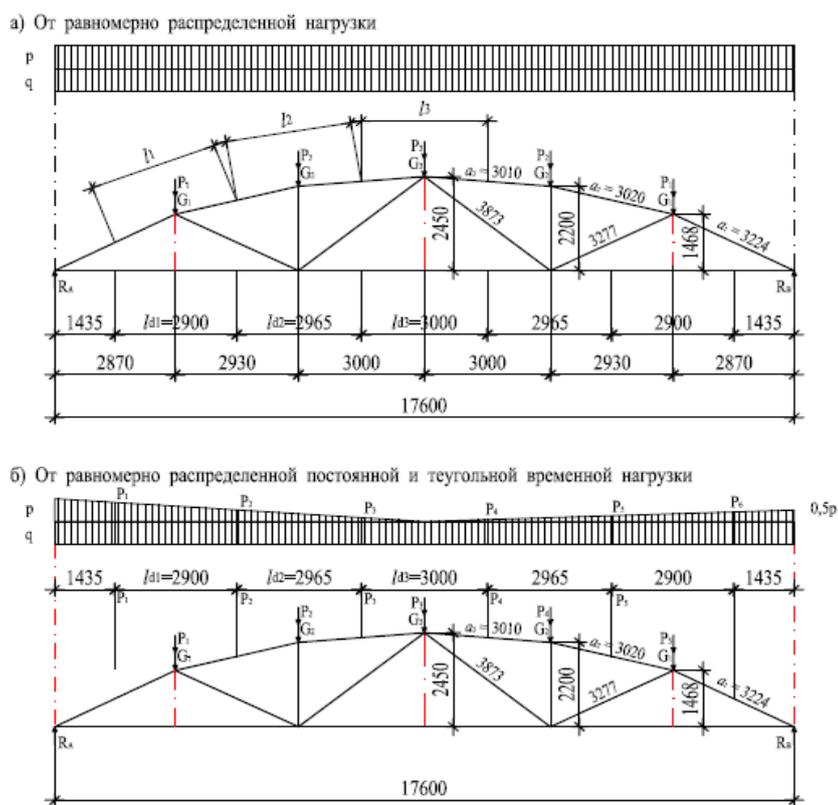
Расчет схемы загрузки фермы 2ФС–18
